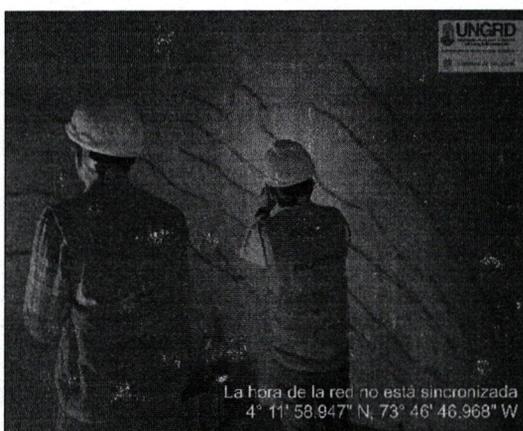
Se evidencia fisuras en el apoyo del puente
